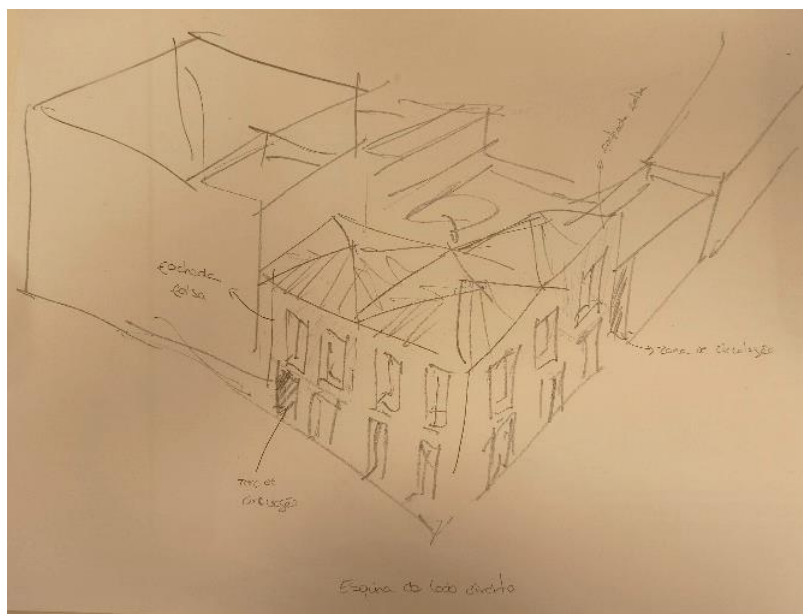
Esboço do projeto da fachada. Fonte: Arquiteto João Carriço
